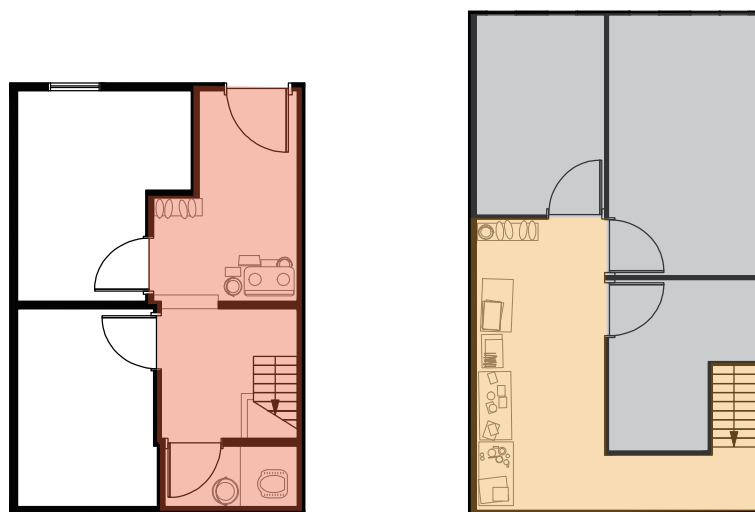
コス⑬;一階平面図 (左) と 2 階平面図 (右) (1:50)
